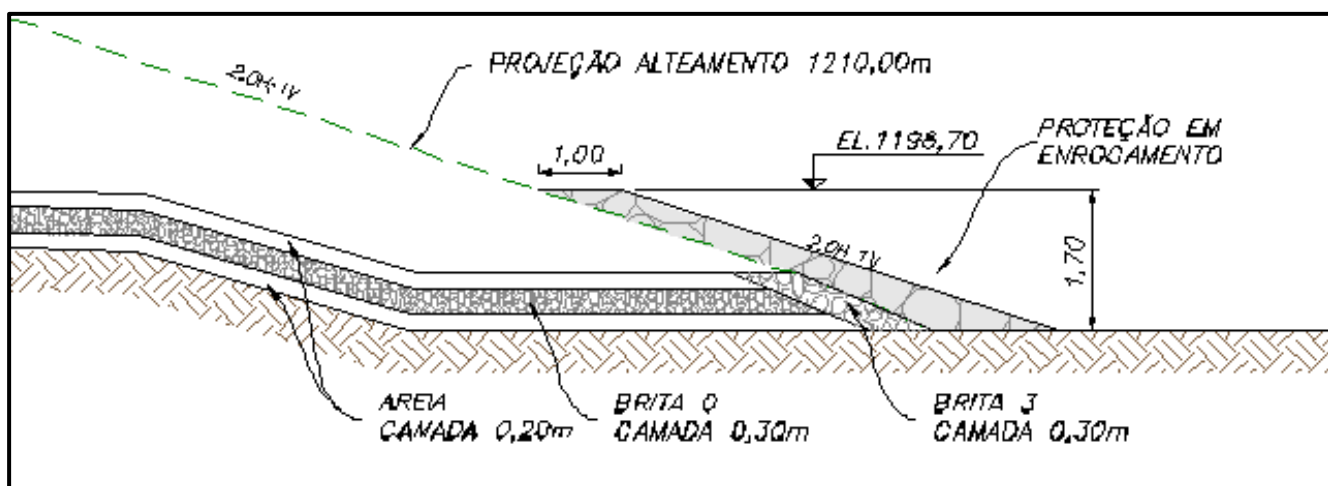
Detalhamento da saída drenagem interna mostrando a camada drenante, as transições e o enrocamento, como dreno de pé.
